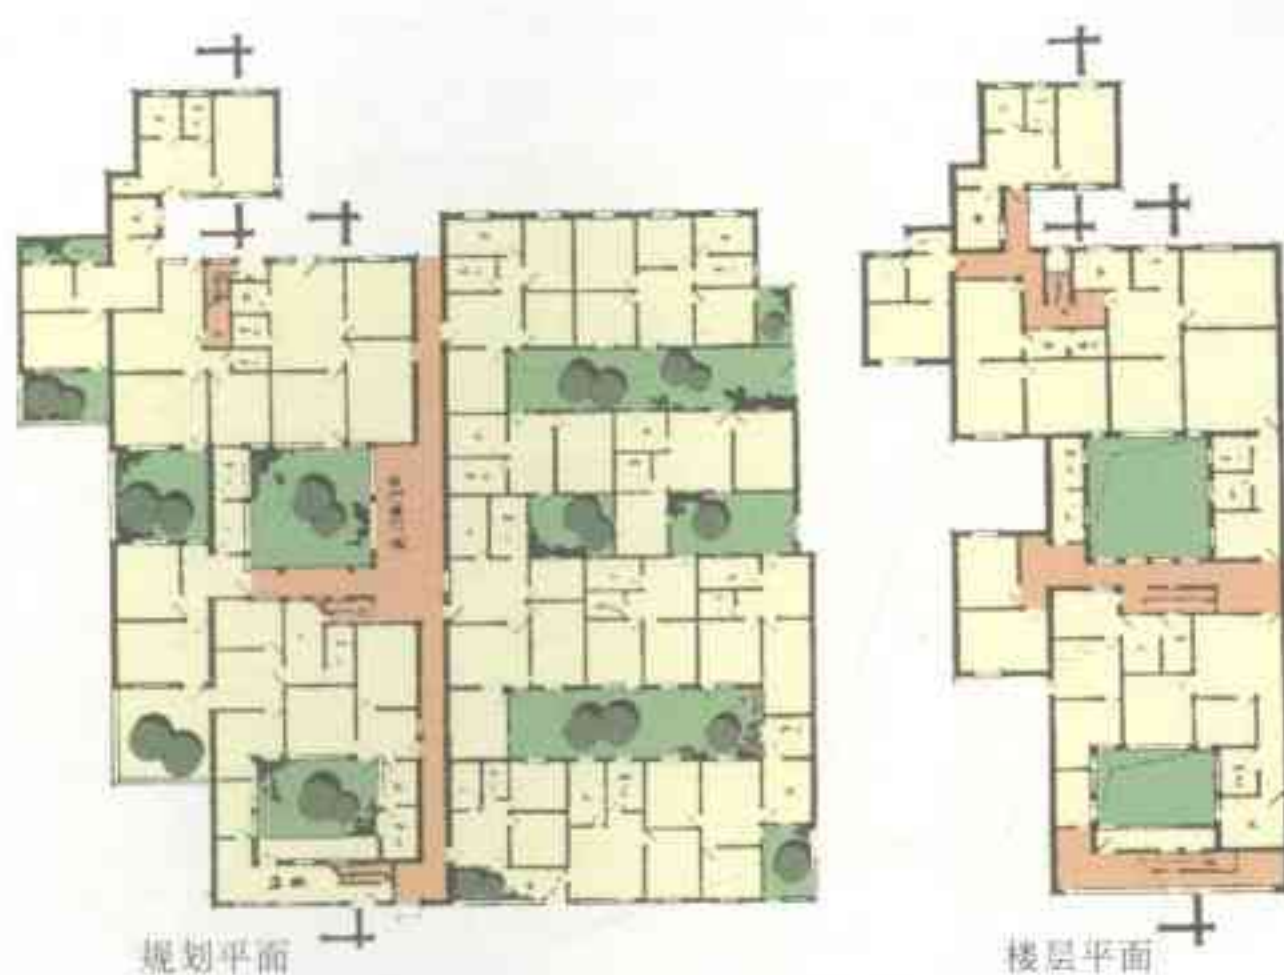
十梓街 50 号民居改造 1——规划平面
